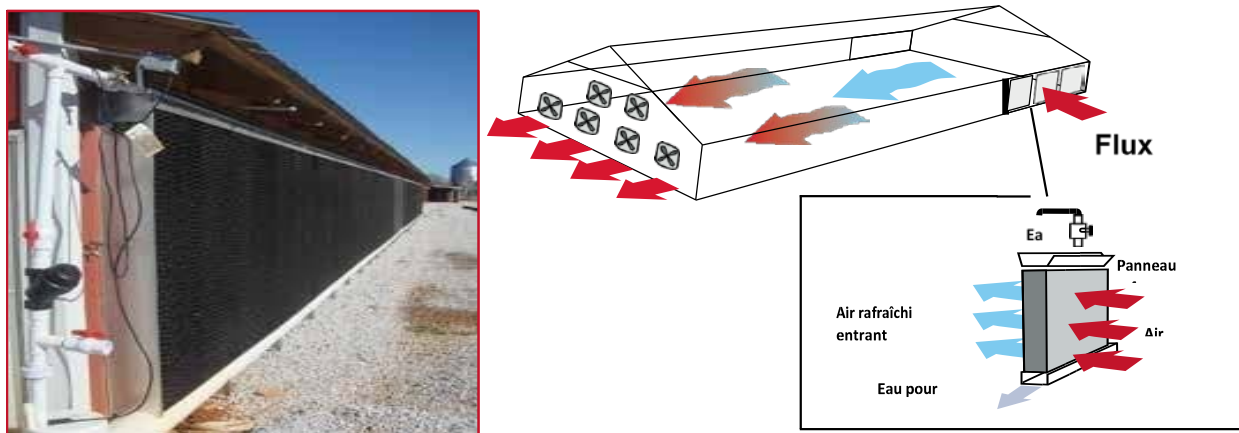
rafraîchissement à panneaux refroidissants avec ventilation en tunnel.
